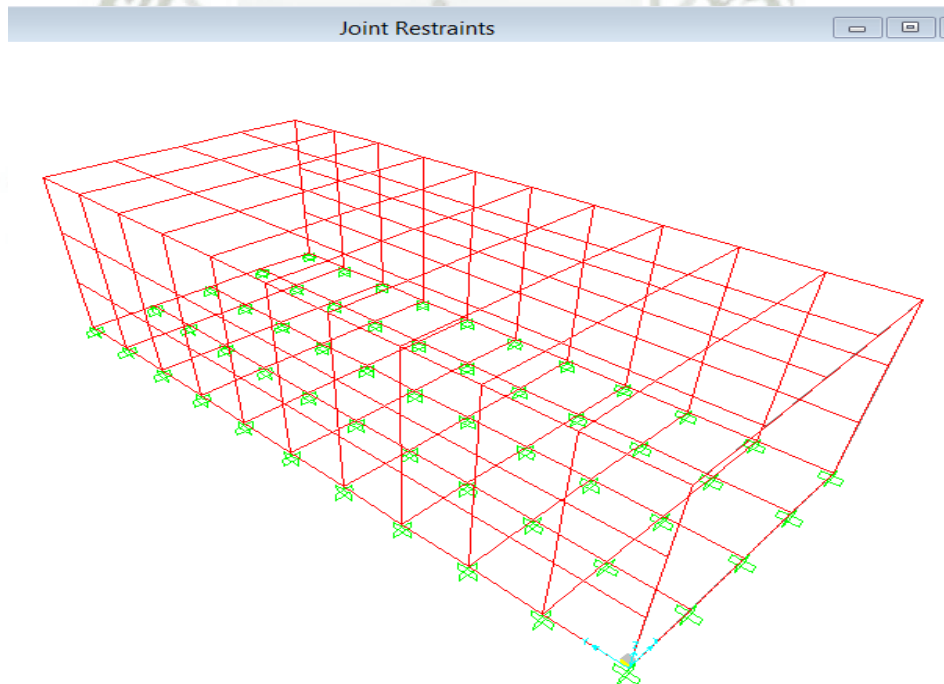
Modelamiento Estructural Alcantarilla (SAP2000)
